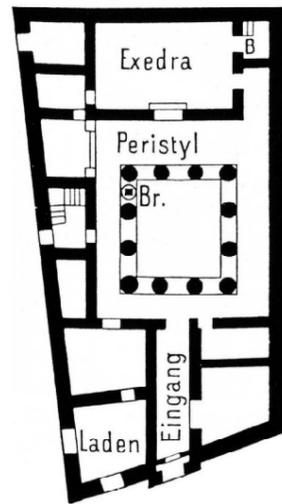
Grundriss eines Hauses in Delos, 4. Jh. v. Chr.
